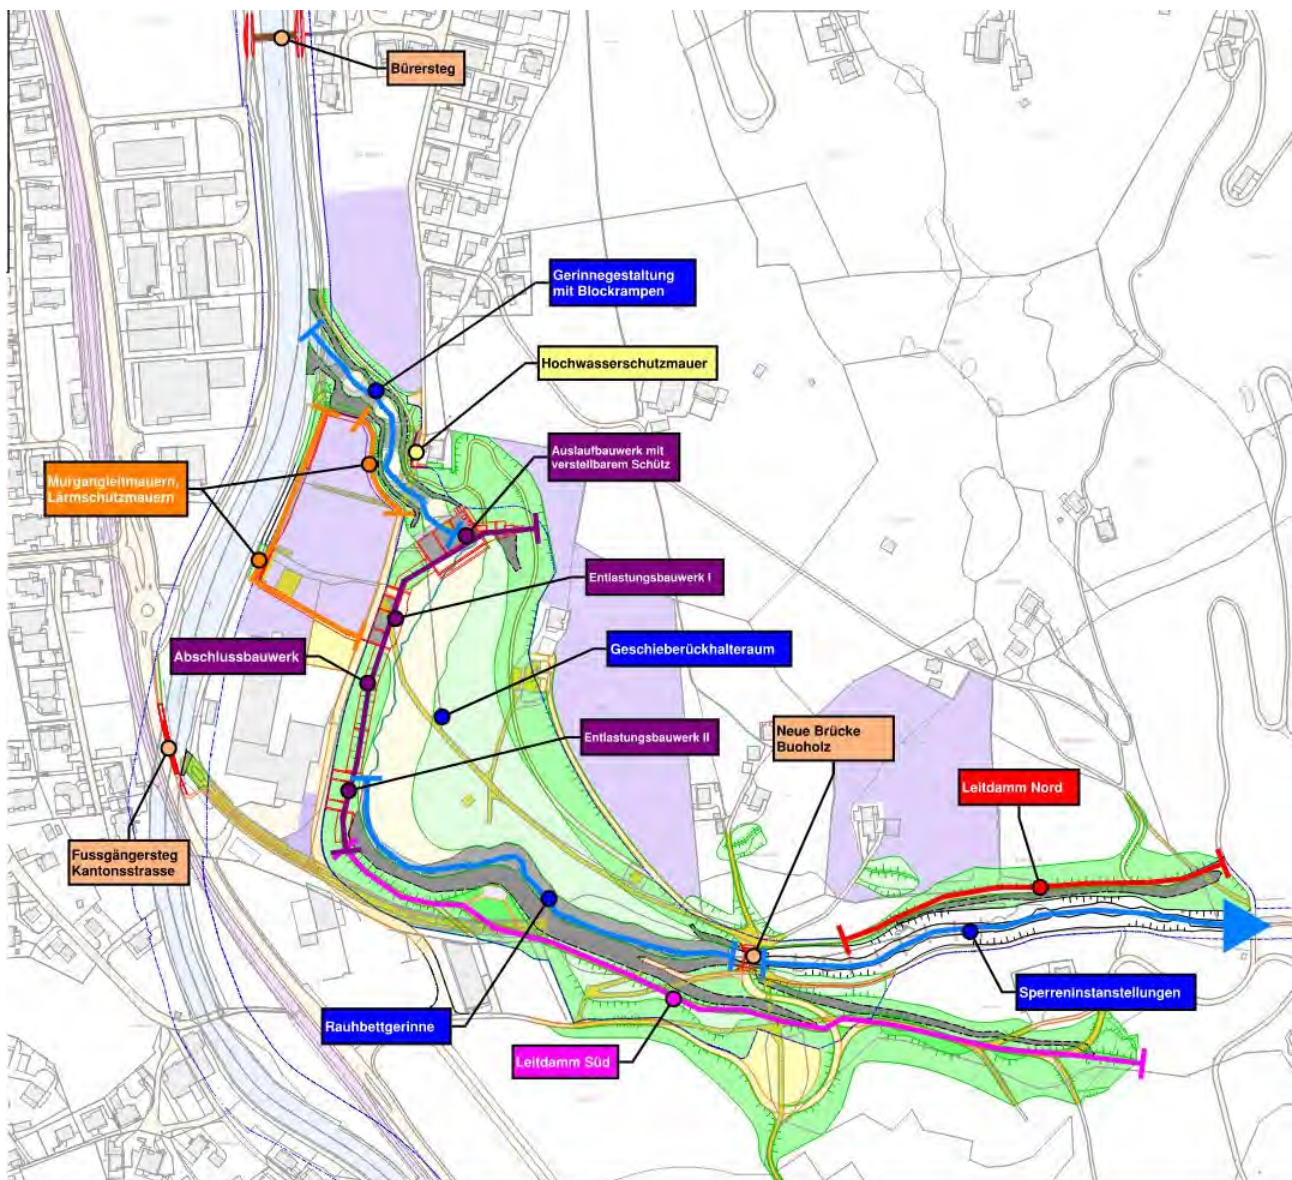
Situationsplan mit den wichtigsten Bauwerken (Quelle: Planausschnitt aus 2287-402)
